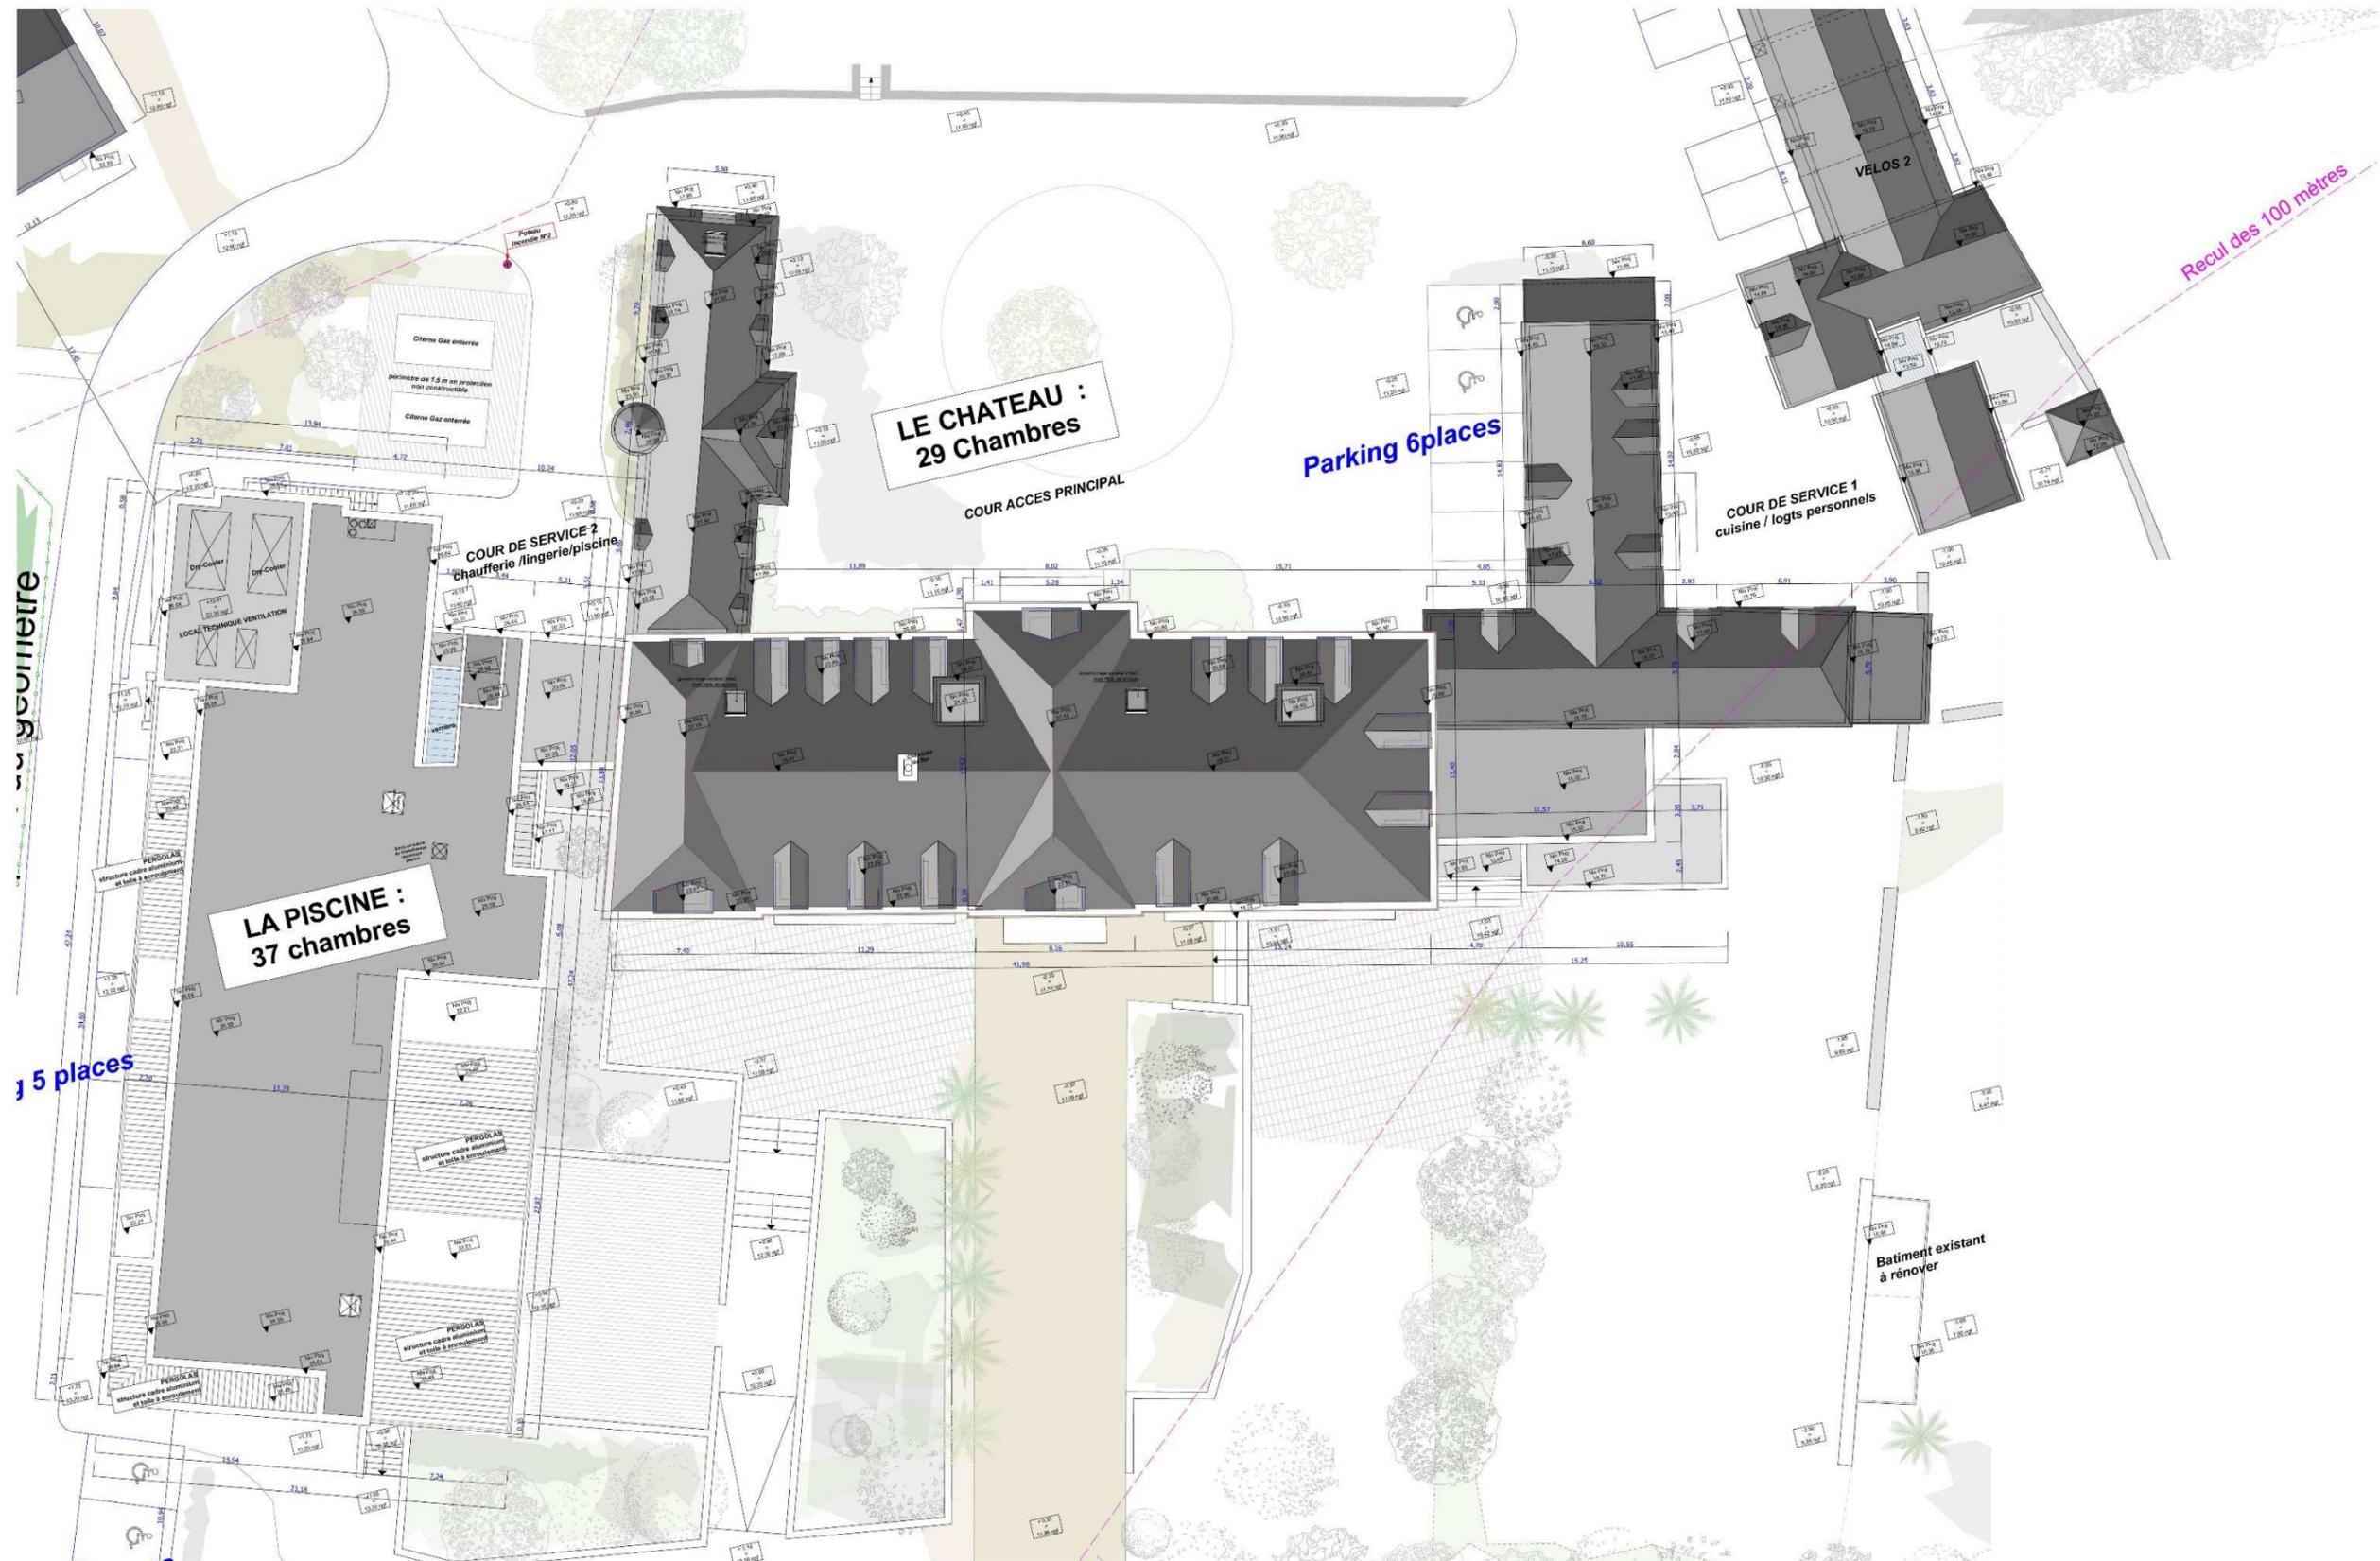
Plan masse du Château (Source : Paumier Architectes Associés)
